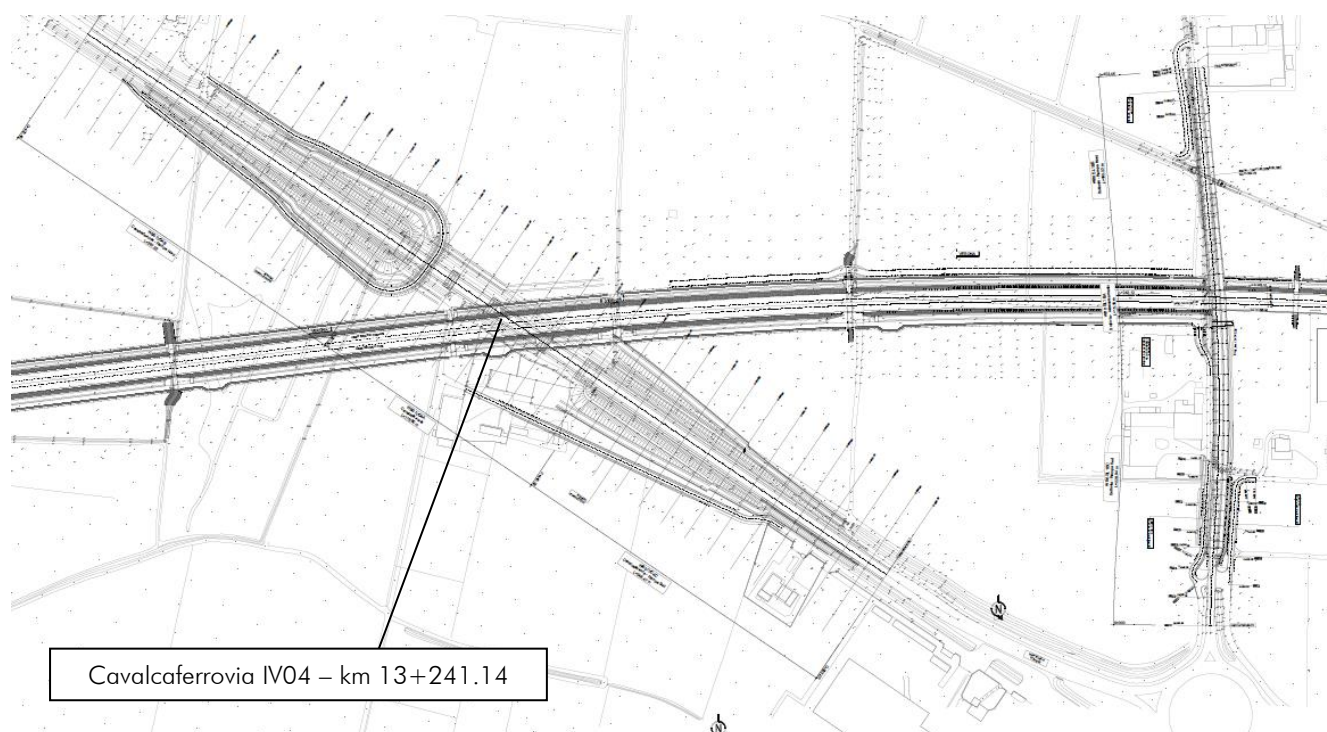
Stralcio planimetrico – Ubicazione Cavalcaferrovia IV04
